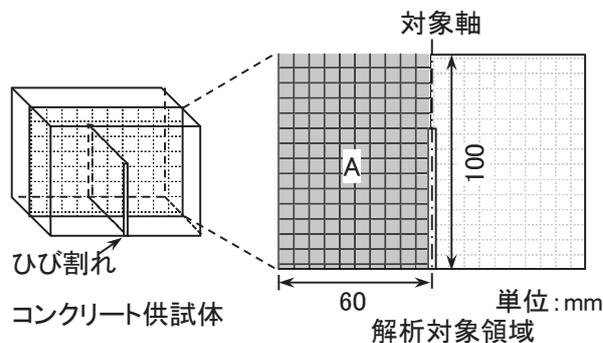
ひび割れを有するコンクリート供試体の解析対象領域
